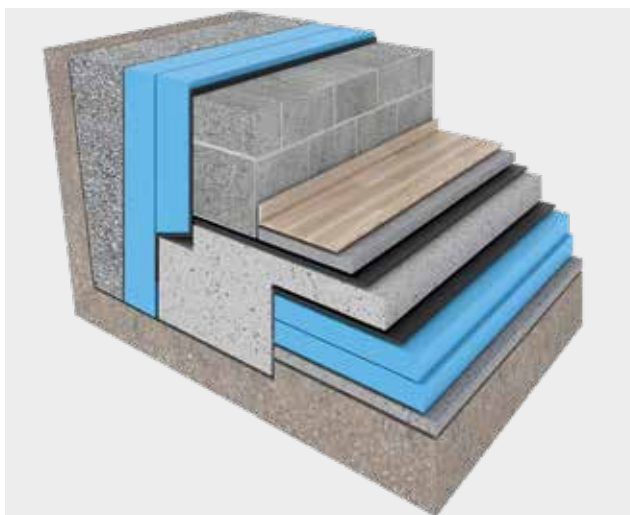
Detailbeispiel Fußpunkt Kelleraußenwand und Wandanschluss
